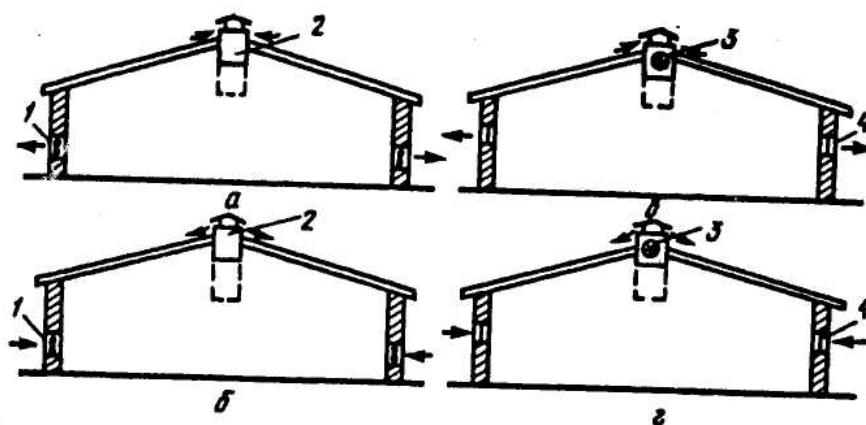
Основные типы летней вентиляции животноводческих помещений: а - вытяжная с настенными вентиляторами; б - приточная с настенными вентиляторами; в - приточная с крышными вентиляторами; г - вытяжная с крышными вентиляторами;
